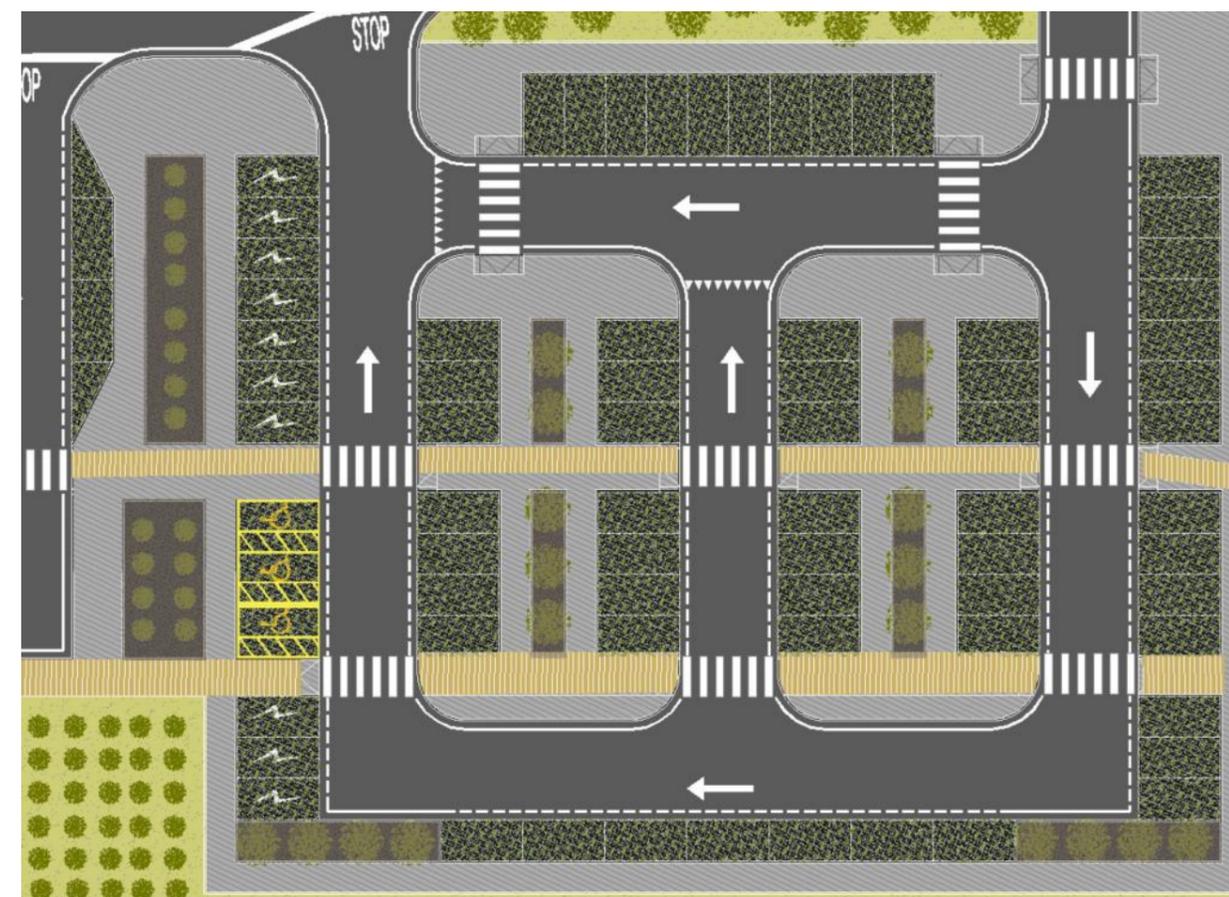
Piazzale di stazione con pavimentazione in masselli autobloccanti
